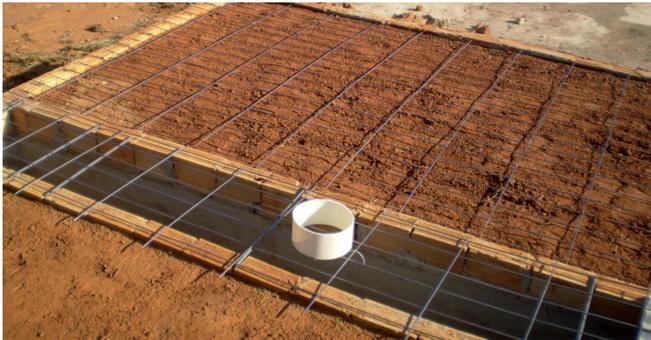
Detalhe da construção da laje piso e colocação dos anéis de PVC para formar a tomada de ar quente.
